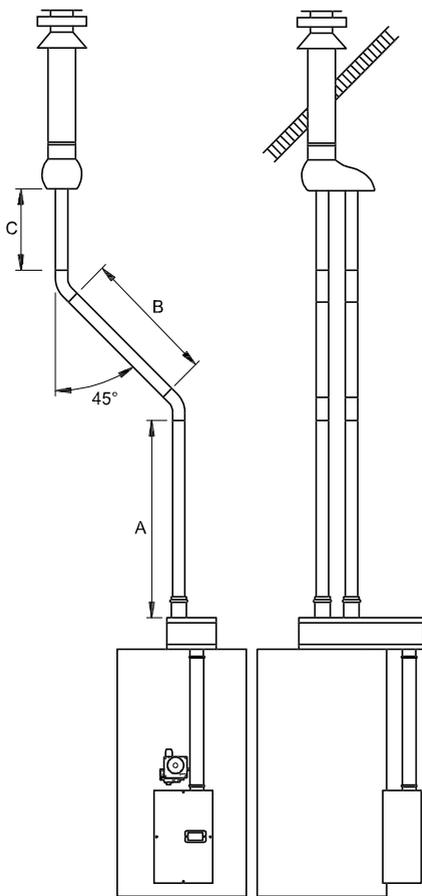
/6 Aufmaß Dachdurchfuhrrohr
